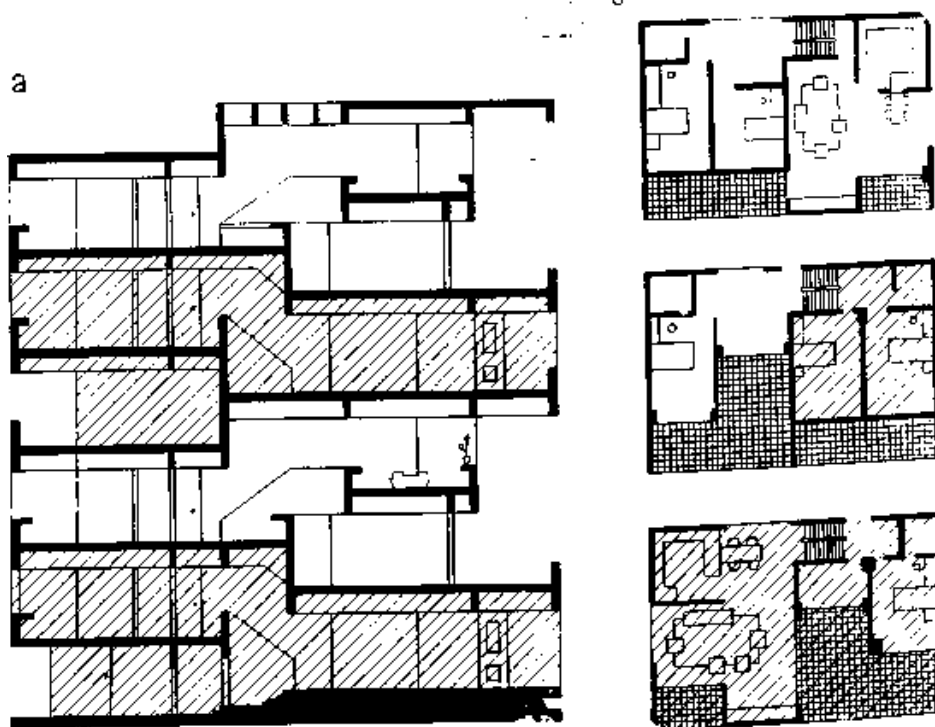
Схеми планувальної компоновки галерейних житлових будинків: а – розріз; б – плани.
